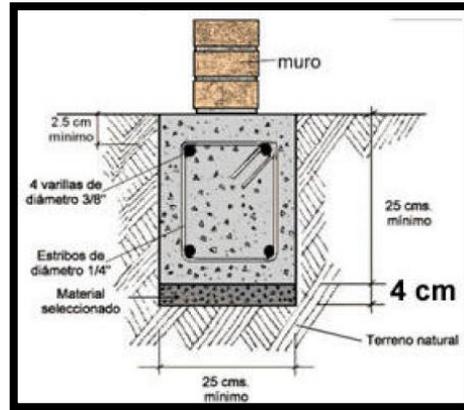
Detalle de Cadena de Amarre para vivienda de 1 planta
